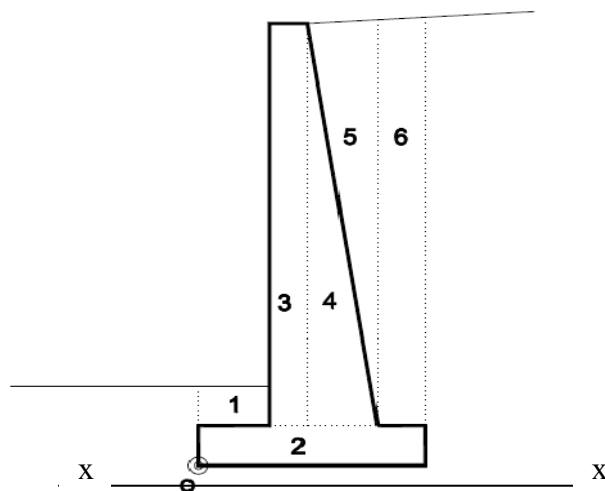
3 detalle de áreas en muro de mampostería de piedra.
